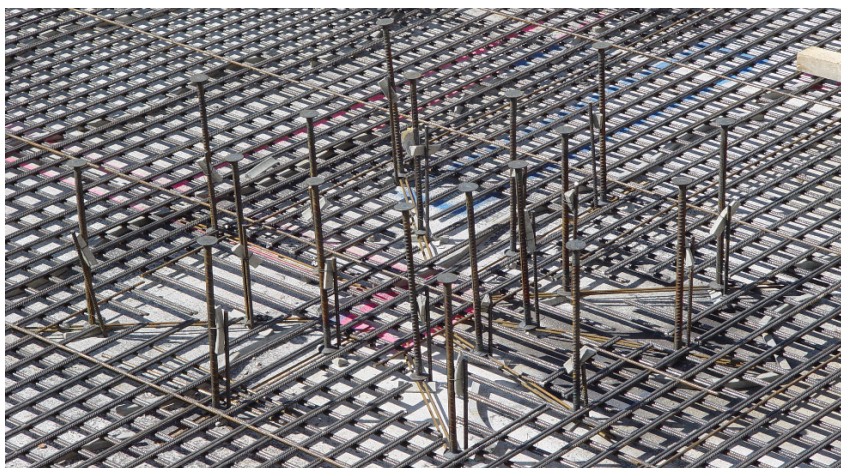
Einfache Dübelleisten, von unten in der Bodenplatte sternförmig um die einlaufende Stütze herum eingebaut
